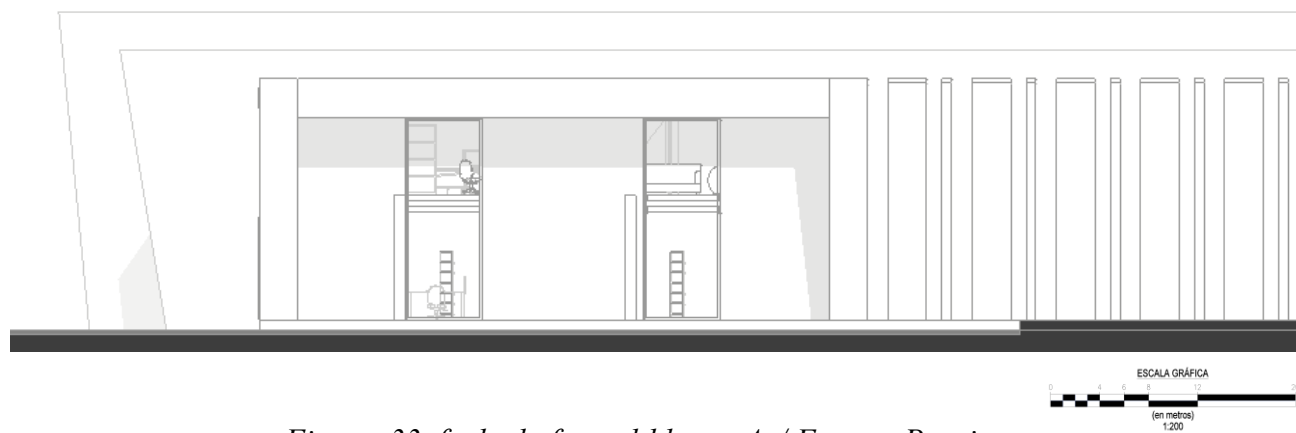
fachada frontal-bloque A. / Fuente: Propia
